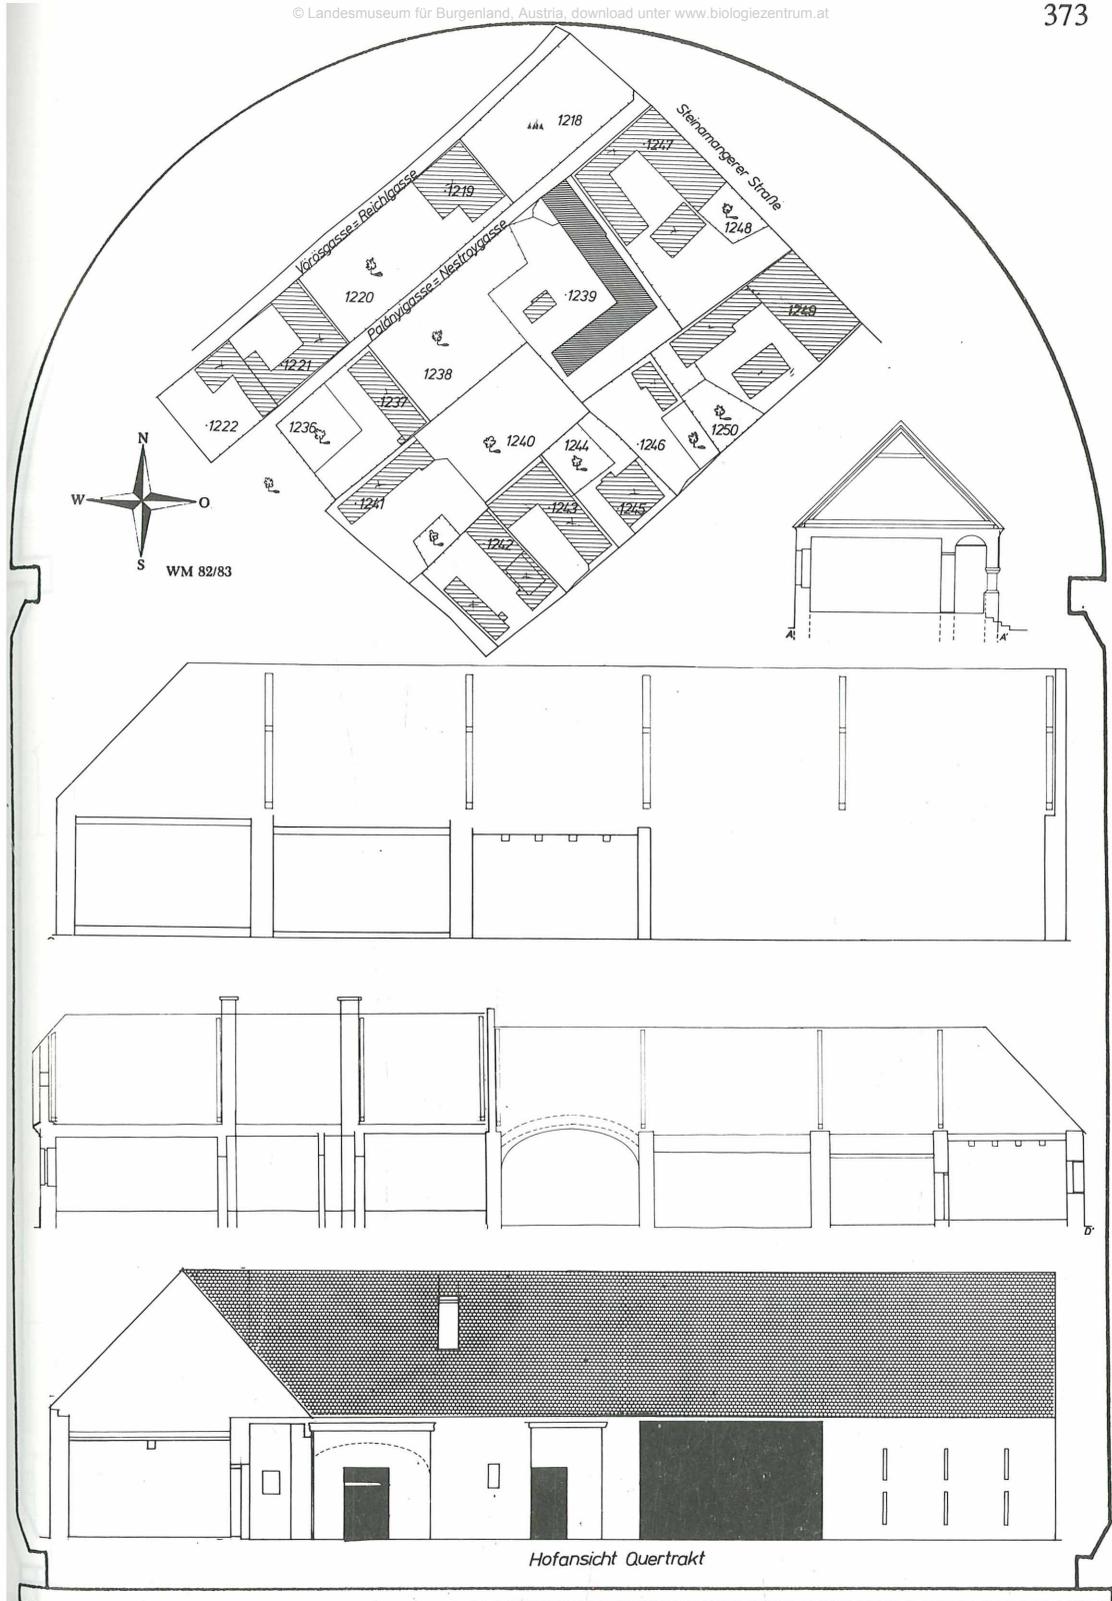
Oberwart, Nestroygasse 1 - Schnitte, Details und Lageplan
